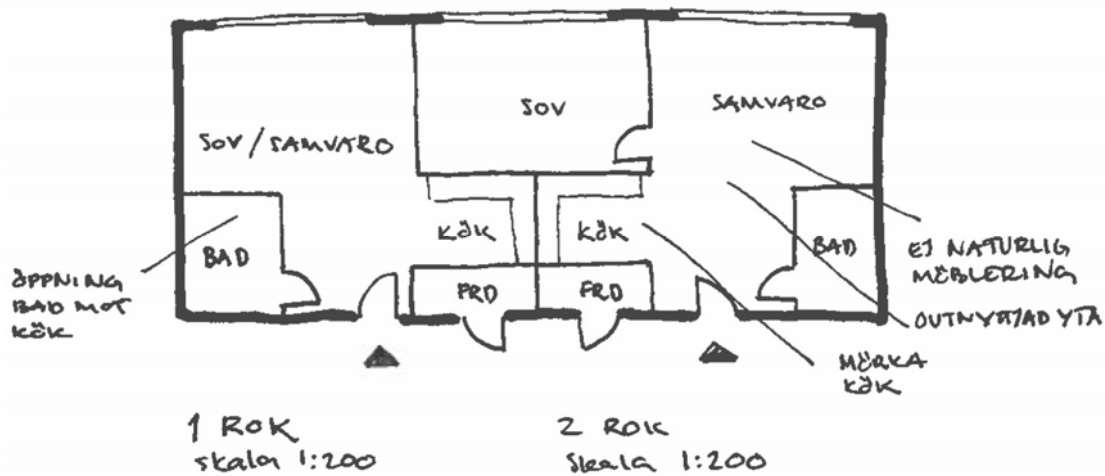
6.3.1, 1 ROK, Kallebäcks äldreboende
